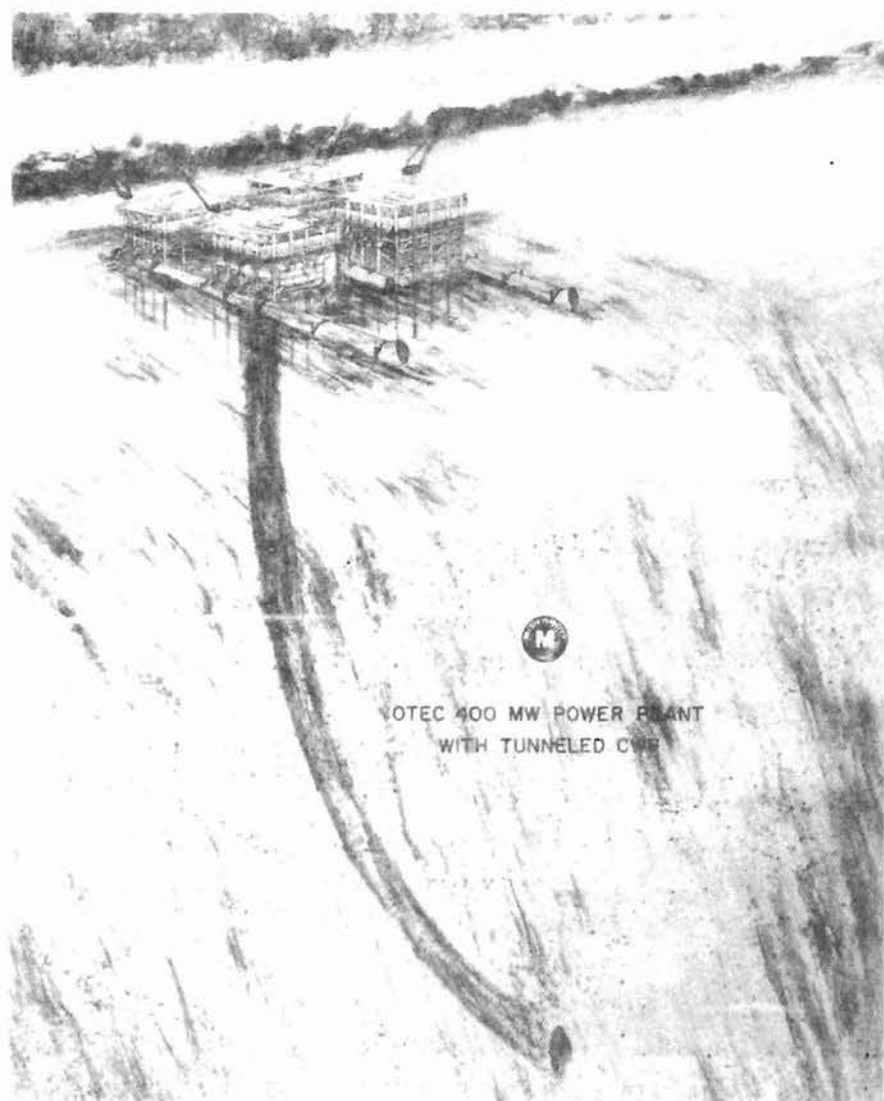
CENTRALE SUR PLATE-FORME AVEC TUYAU EN TUNNEL
